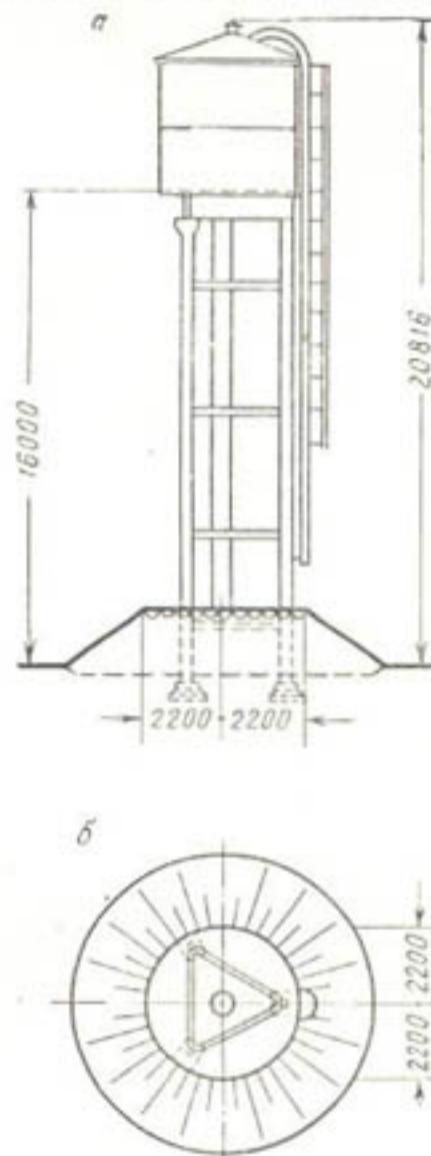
Водонапорная башня с баком емкостью 25 м<sup>3</sup> на сборных железобетонных опорах высотой 16 м:
